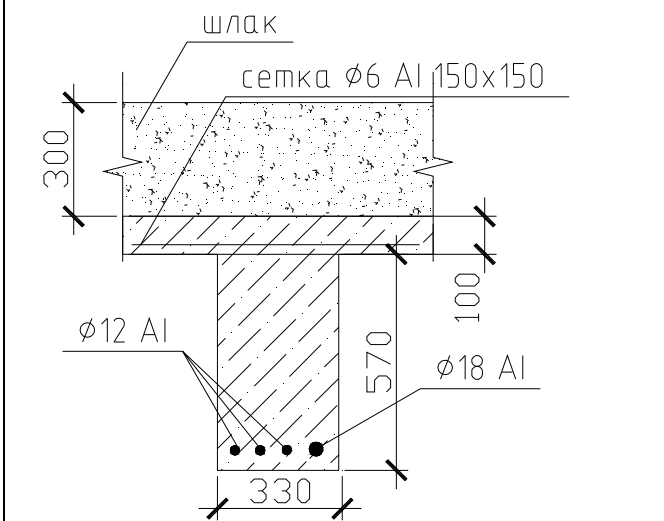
Главная балка ж/б перекрытия над пятым этажом в осях «8–9/А–В»
